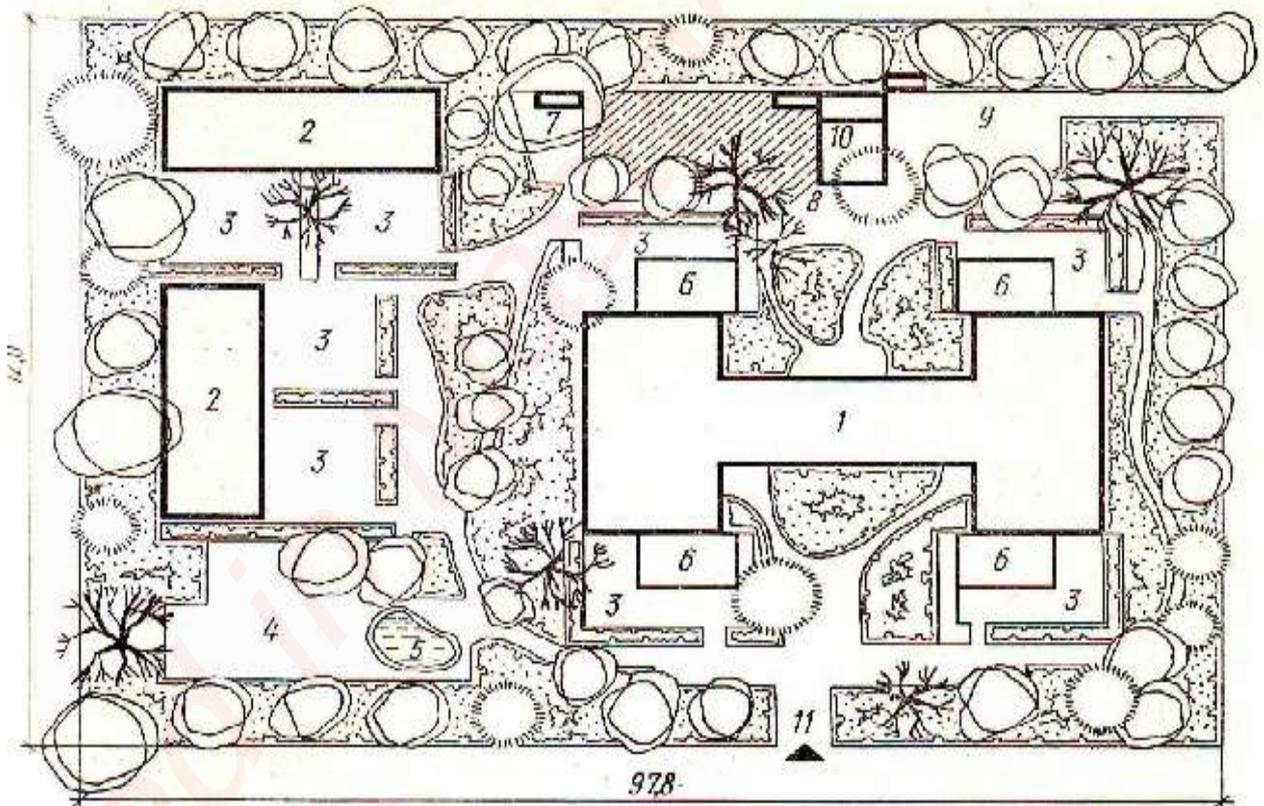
Генеральный план участка детсада на 90 мест:
